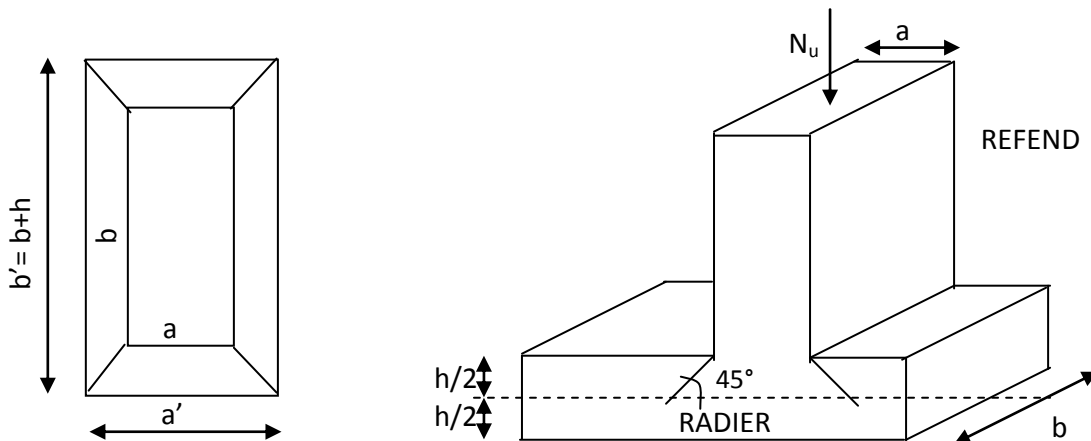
Périmètre utile des voiles et des poteaux.
